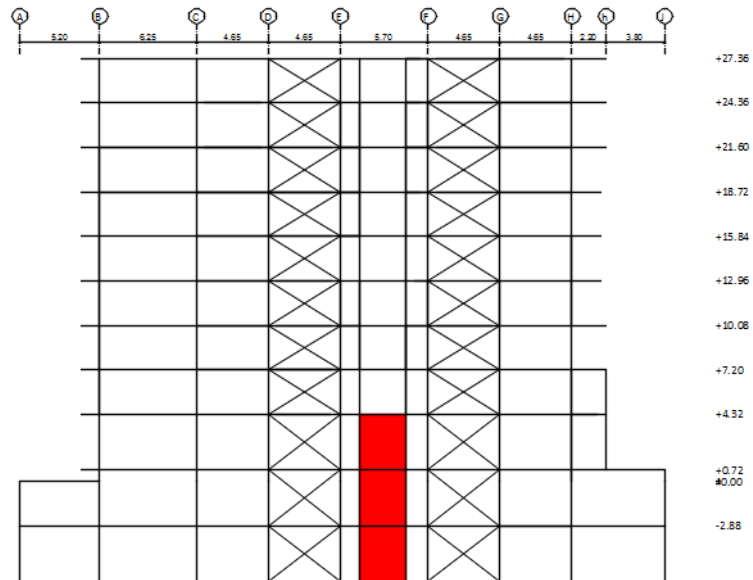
Disposición de diagonales rigidizadoras en pórtico 2
